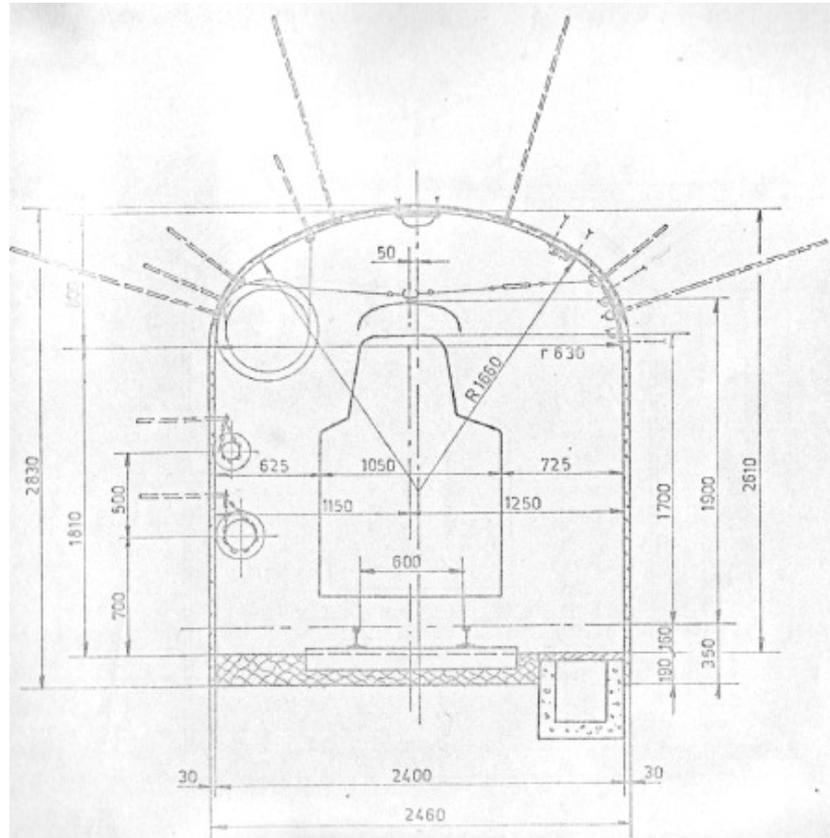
Stollen mit einer Sicherung aus Ankern mit Spritzbeton und Gitter - eingleisige gerade Strecke
